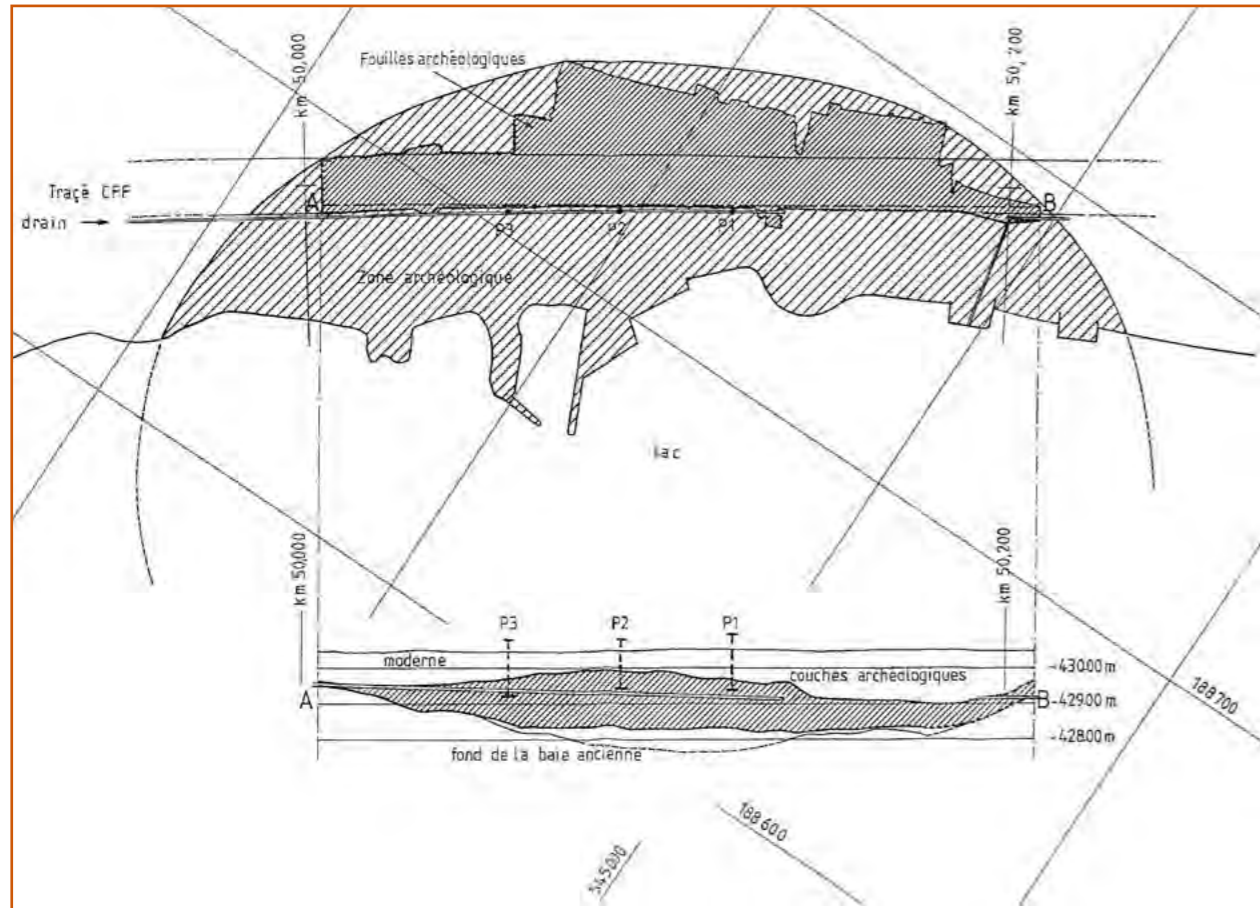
Concise. Plan d'ensemble du site, de la zone fouillée et l'emplacement des piézomètres. La coupe A-B est projetée dans l'axe de la cuve ferroviaire. (Dessin M. Klausener AC-VD).
